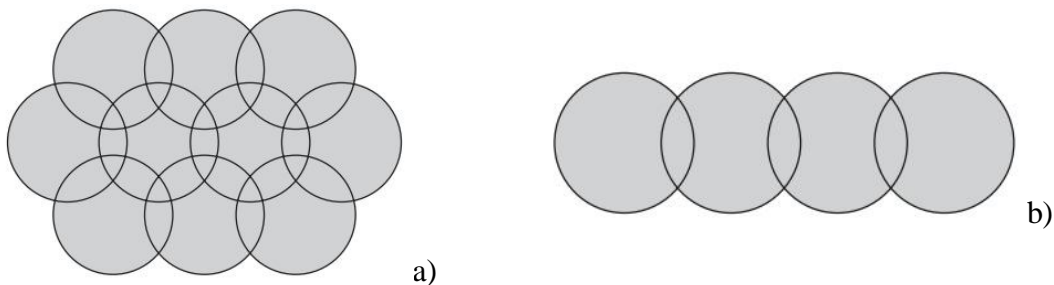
a) Geometria hexagonal conseguida através da intersecção de diversas colunas de *jet-grouting*;
